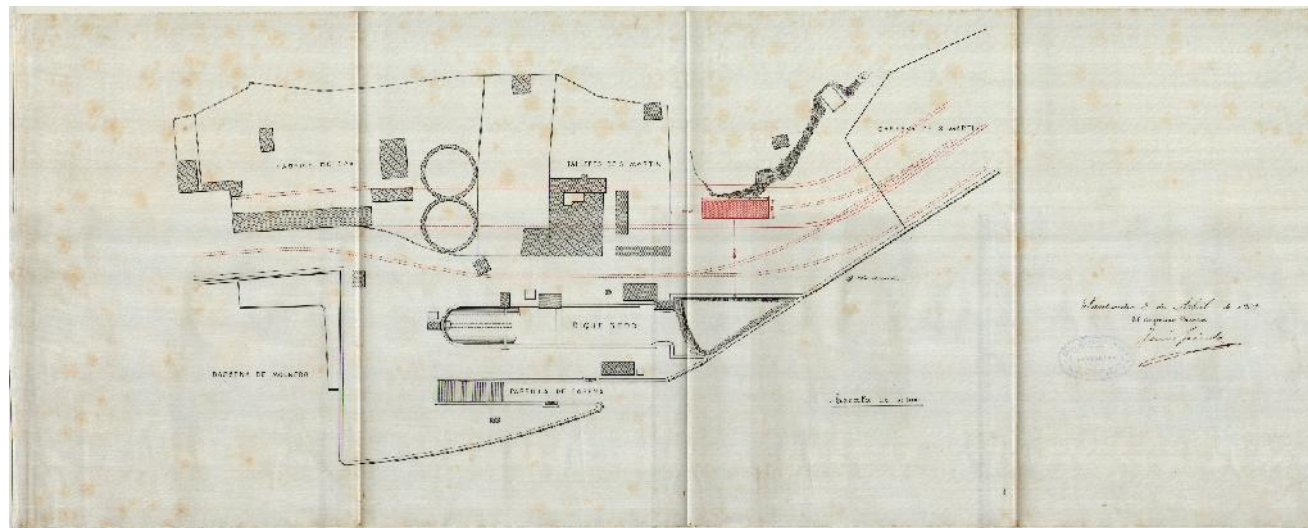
Plano de Situación del Almacén dentro del muelle. Contenido en el Proyecto de 1901.
